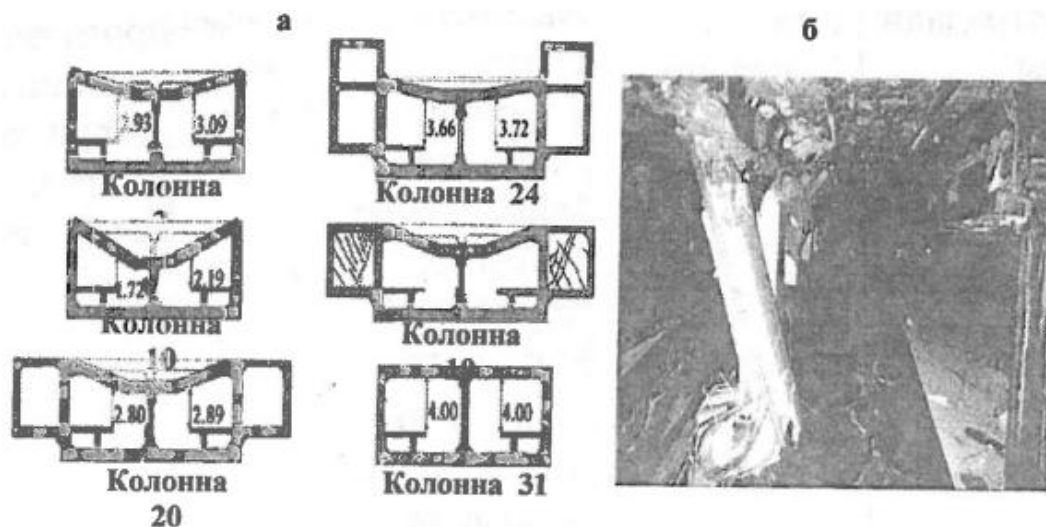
Разрушенные: а – кровли, бока и б – колонны станции Daikai метрополитена в городе Кобе
